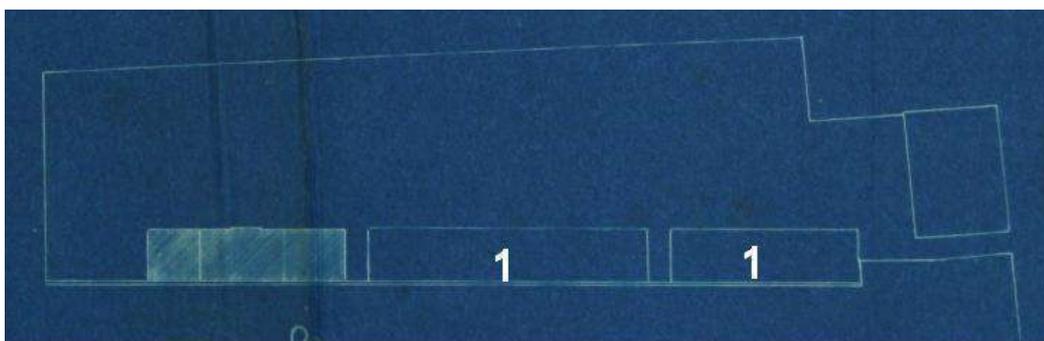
Primeira fase construtiva do polo industrial da Mitra, com a construção de dois barracões, Março de 1913
